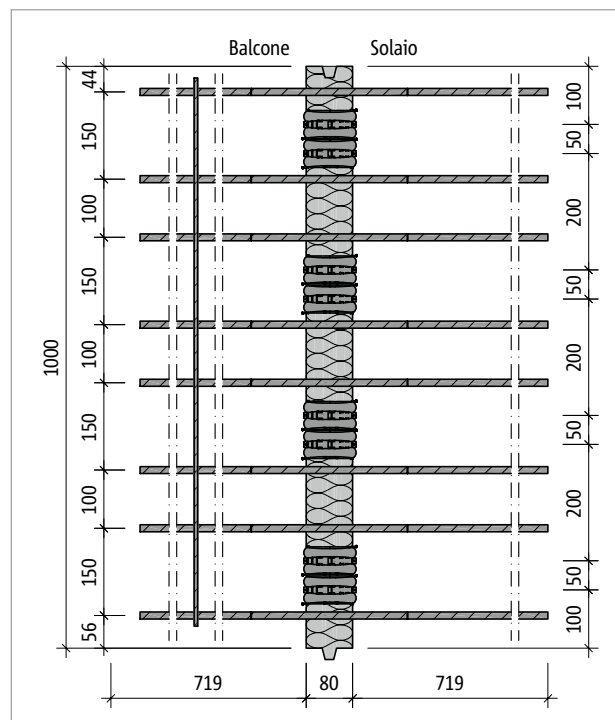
Schöck Isokorb® T tipo QL-V6: pianta del prodotto
